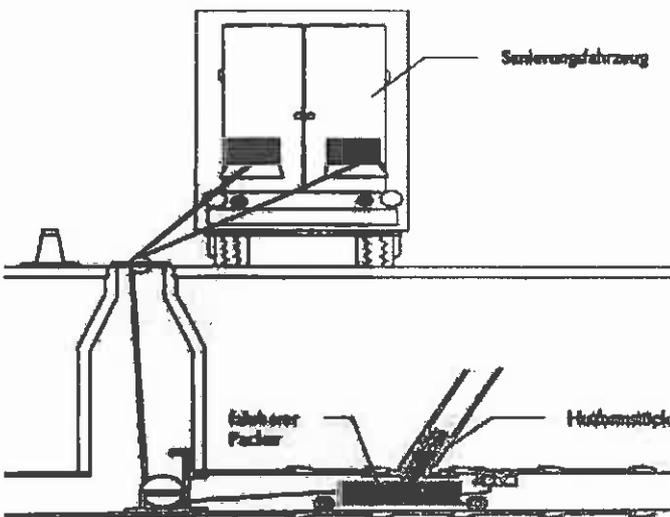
Sanierung einer Anschlussleitung mit Hutstück (Quelle Rabmer)
